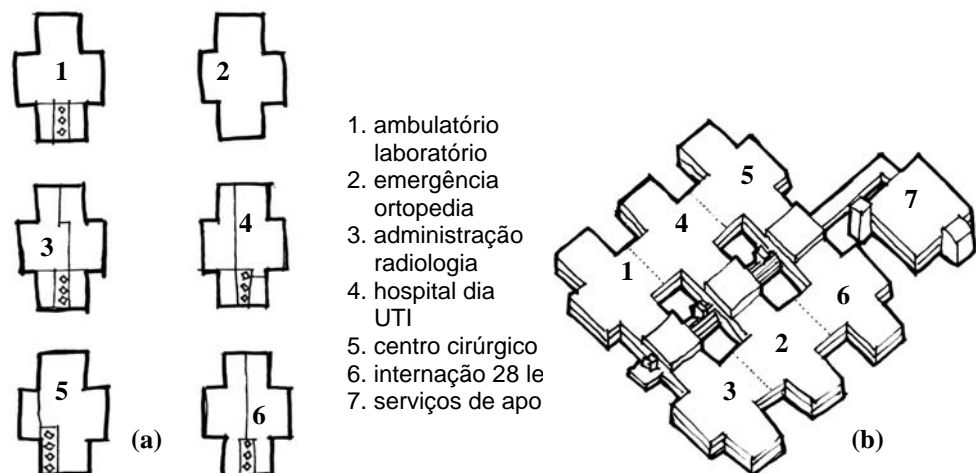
Best Buy Hospital, Bury St Edmunds, 1967. (a) planta; (b) croqui.
